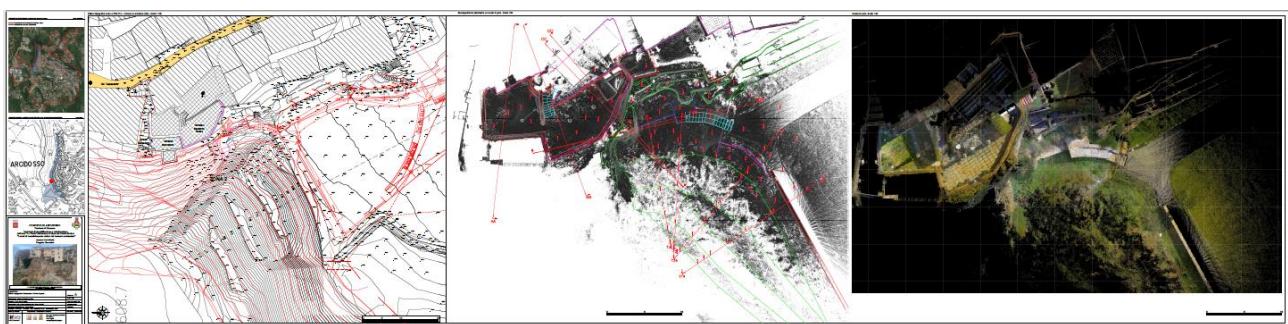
Elab.6 Rilievo topografico digitale - Sezione prospetto con stralcio planimetrico (da quota 626,36 a quota 642,80) Sez.B-B', Sez.C-C' - Sez.D-D'
